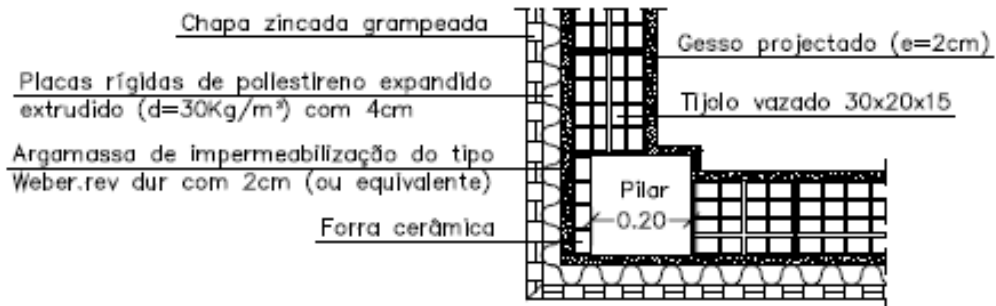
Pormenor de ligação entre duas paredes verticais do piso recuado (Projeto de CT)
